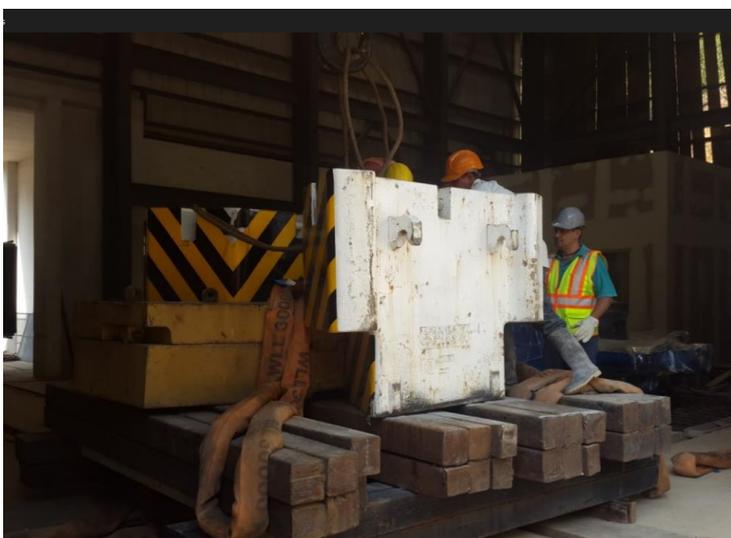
Prueba de carga de la grúa puente con 40 ton.
